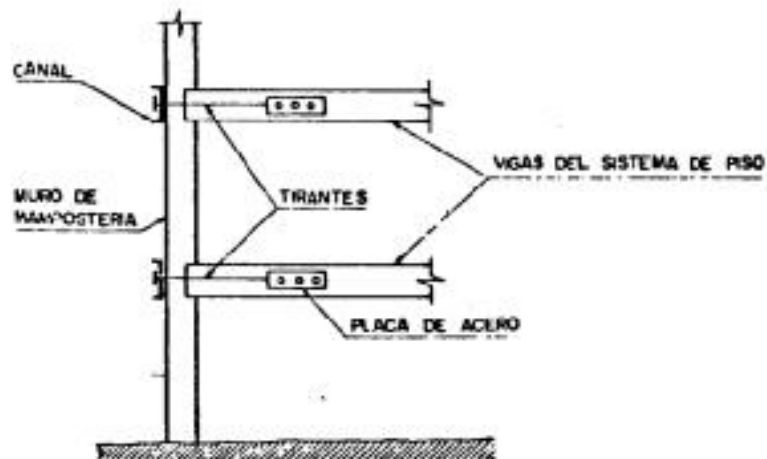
Anclaje de muro exterior a vigas de los sistemas de piso
